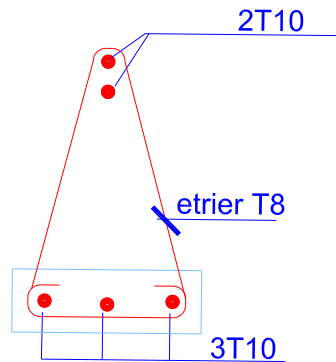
Plan de ferrailage de poutrelle (en appuis)
